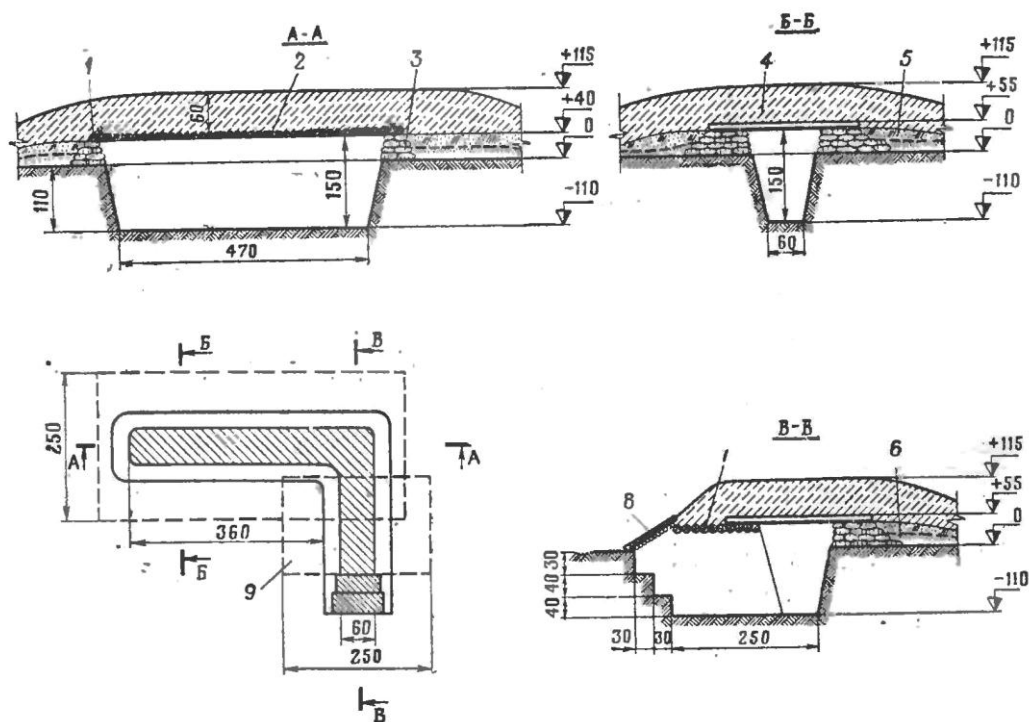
перекрита щілина у мерзлому ґрунті.
